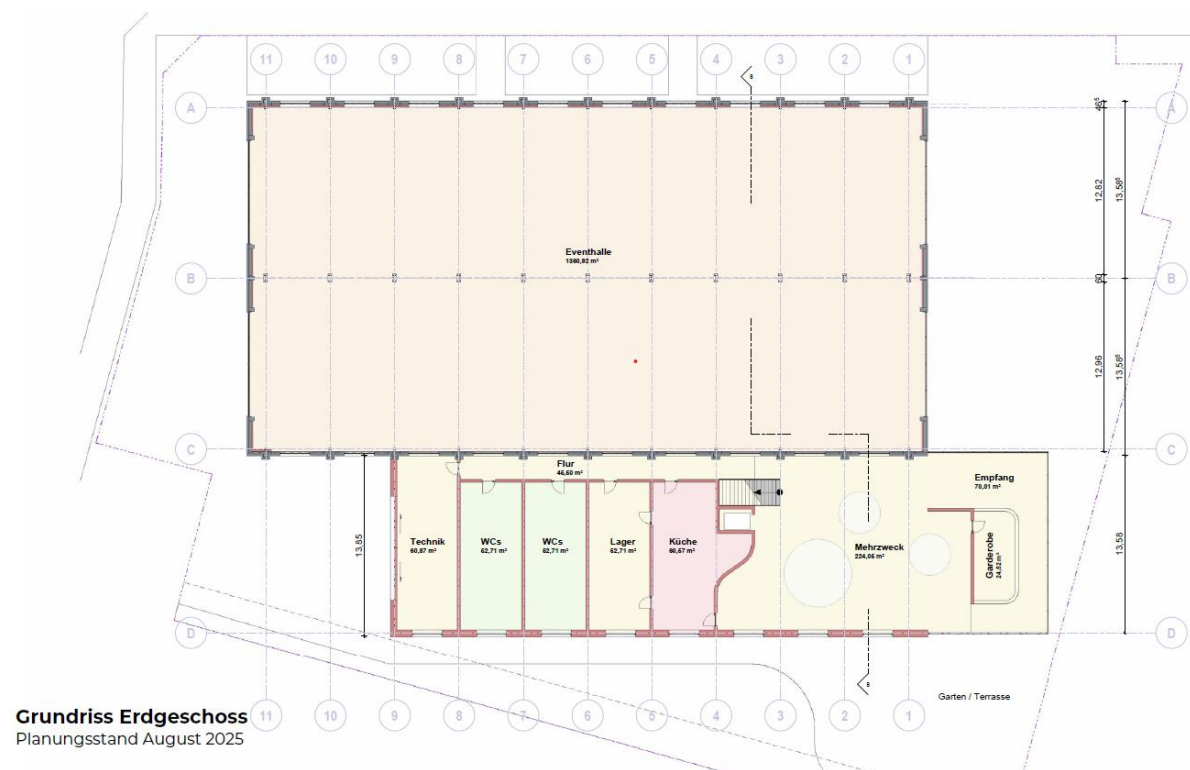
Grundriss Erdgeschoss der Markthalle mit Neubau, Architekturbüro Sven Scholz
